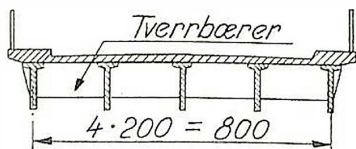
Prefabrikerte spennbetongbjelker med dekke av armert betong.
